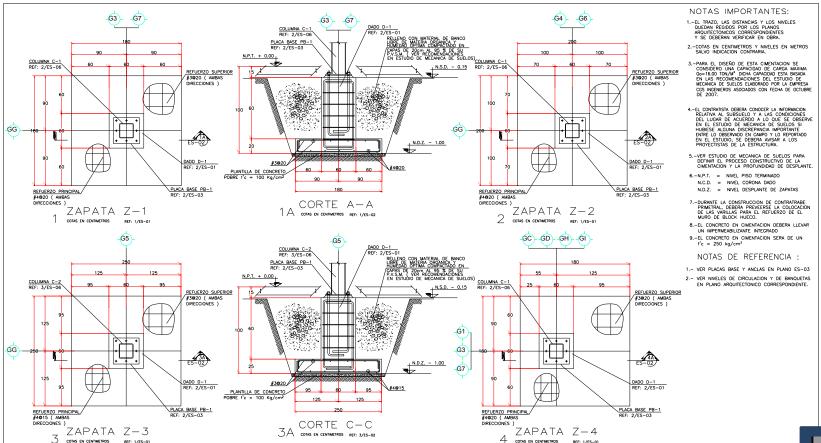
Detalles de Cimentación, Referencia Plano: CPJ-CG-ES- 02.DWG
